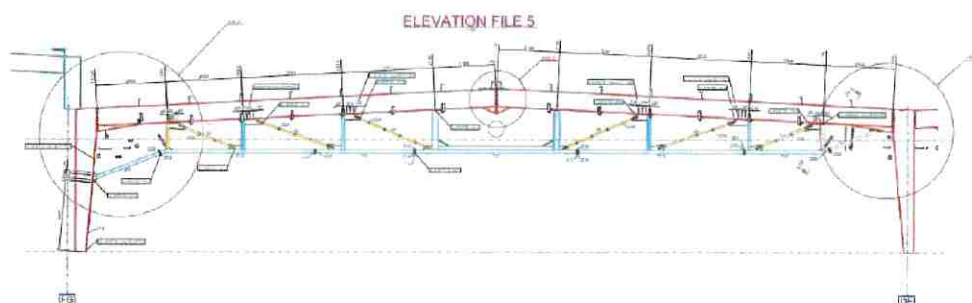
PLAN D'ELEVATION DE RENFORT D'UNE FERME DU BATIMENT
